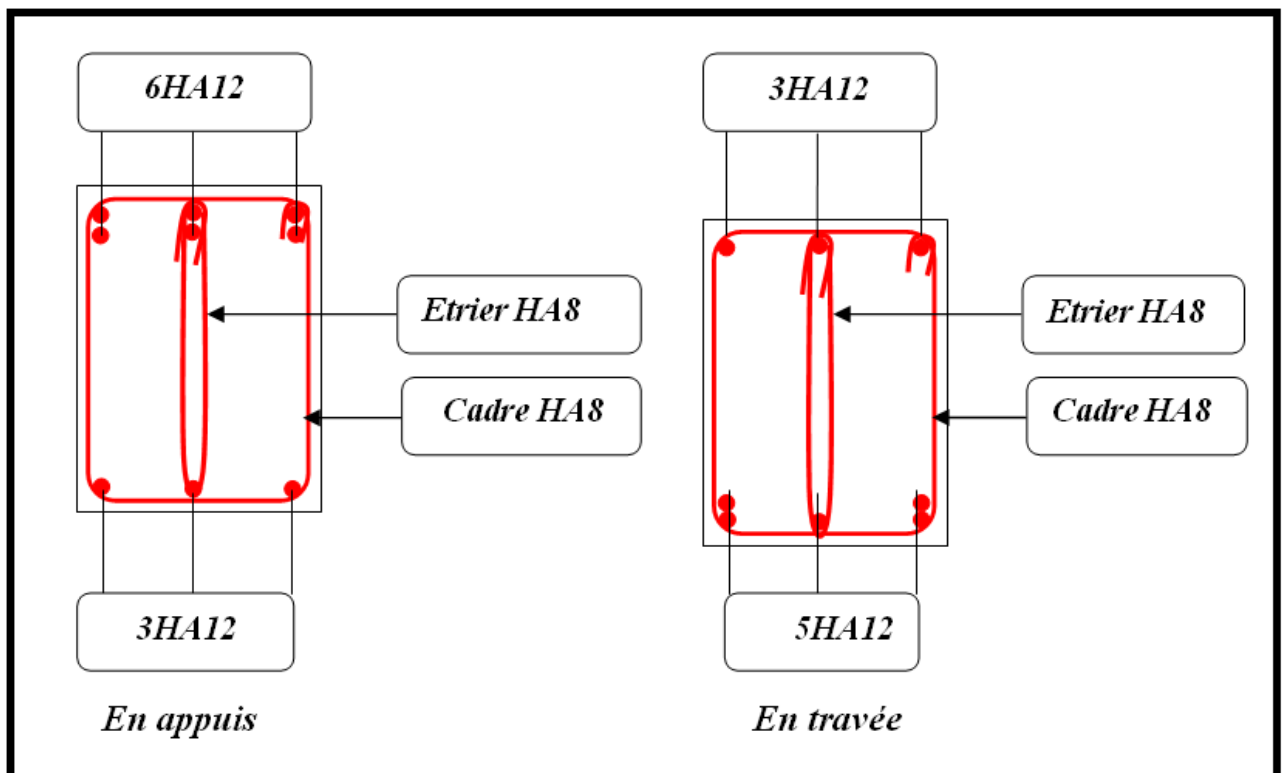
Schéma de ferrailage des poutres secondaires.
